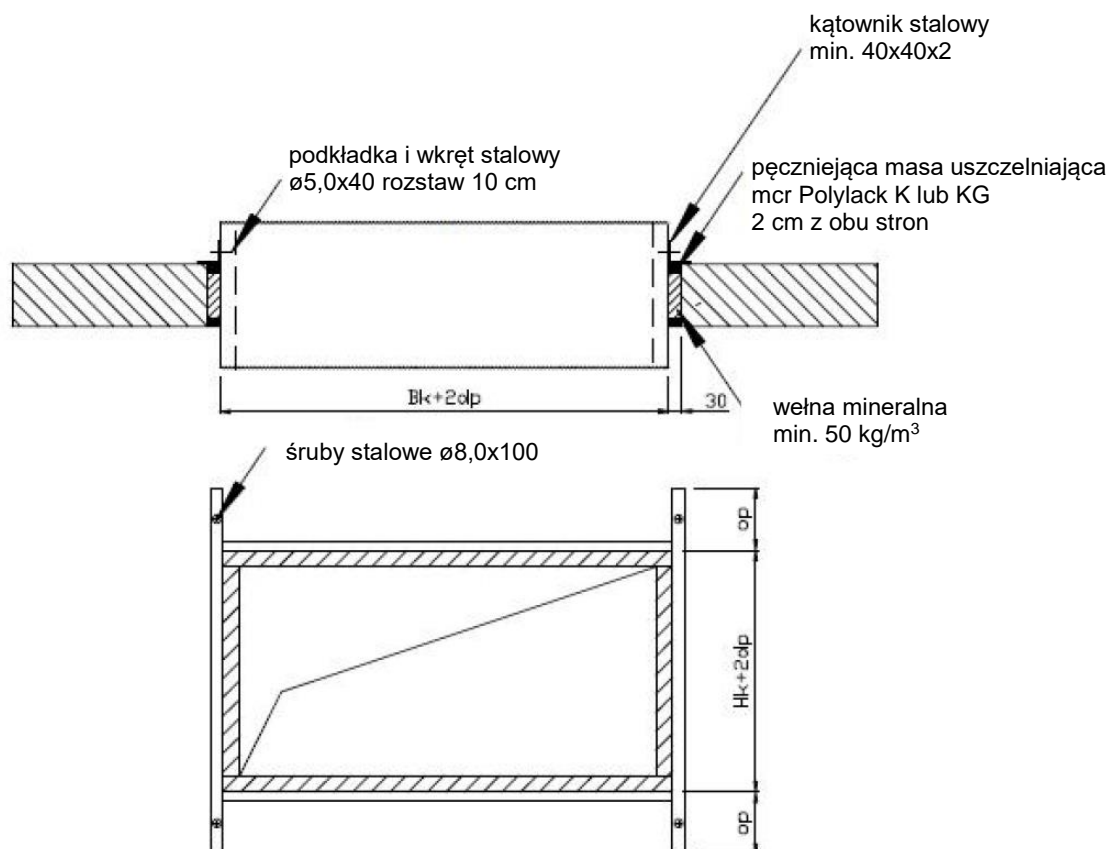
Samonośne kanały wentylacyjne wykonane z płyt mcr SILBOARD - alternatywne przejście przez ścianę murowaną lub betonową.
